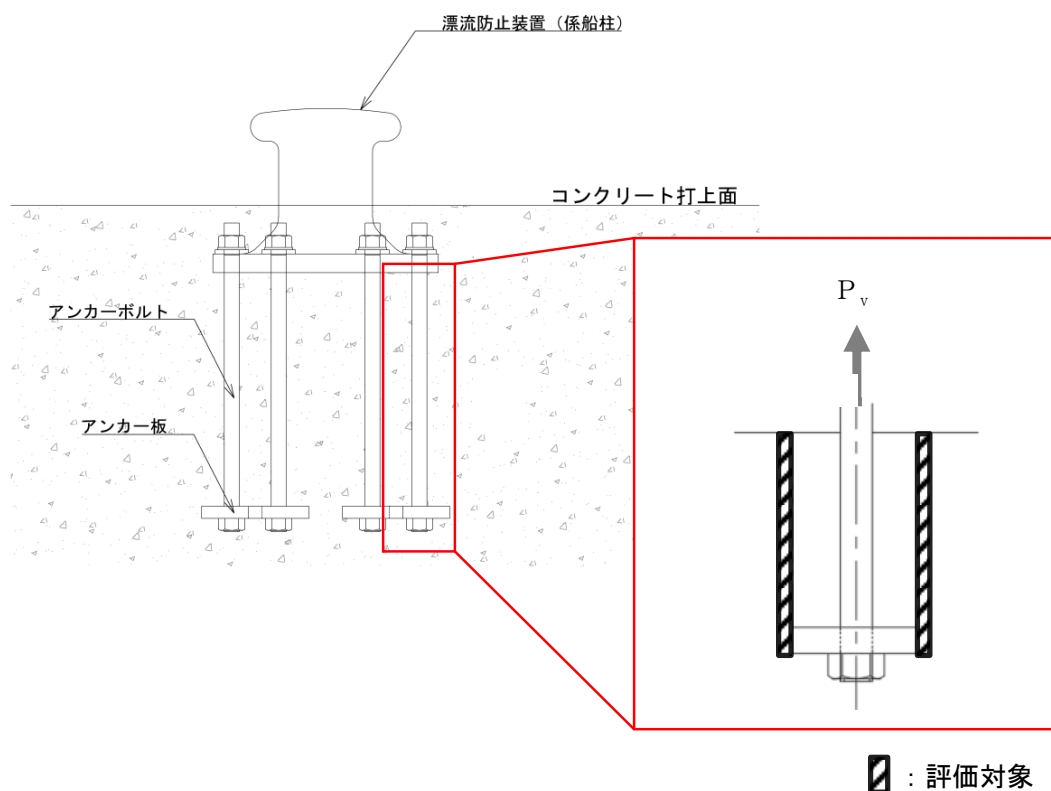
コンクリート（アンカーボルト側面）のモデル図
